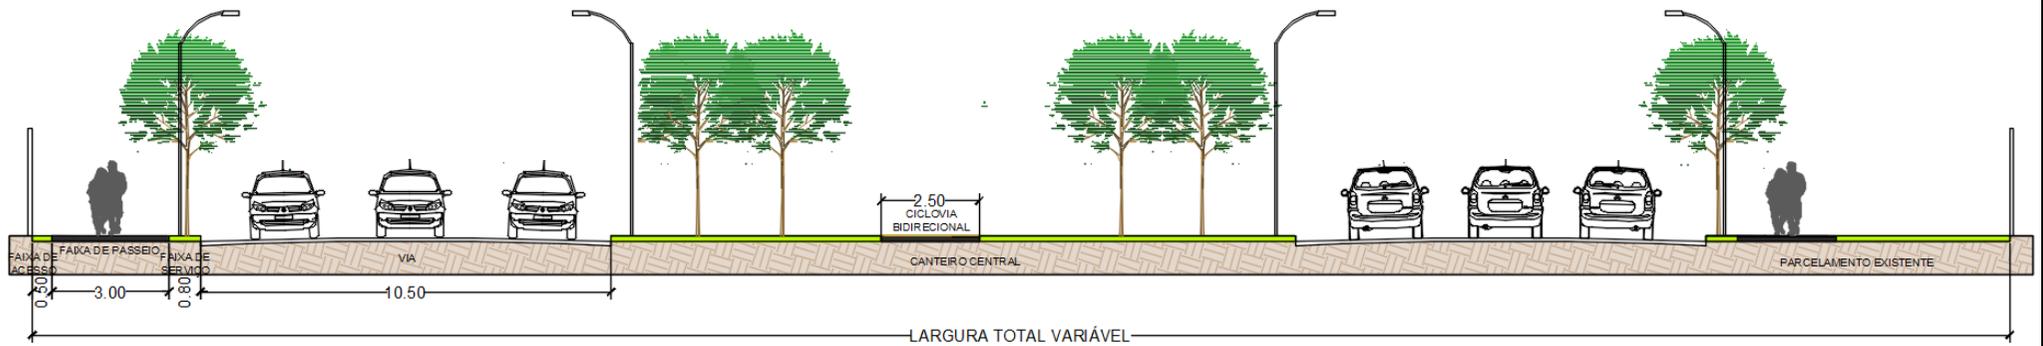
Perfil da Via de Atividades – Perfil 01 – Paralela a BR-070 (via existente) (Fonte: Própria)
